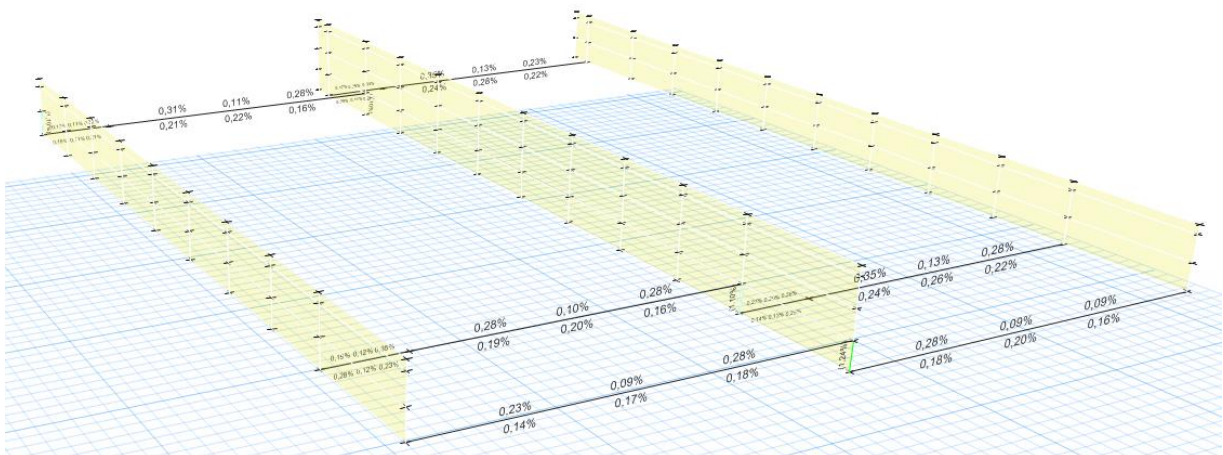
Refuerzo Longitudinal vigas en el modelo de aulas bilingüismo [%]
